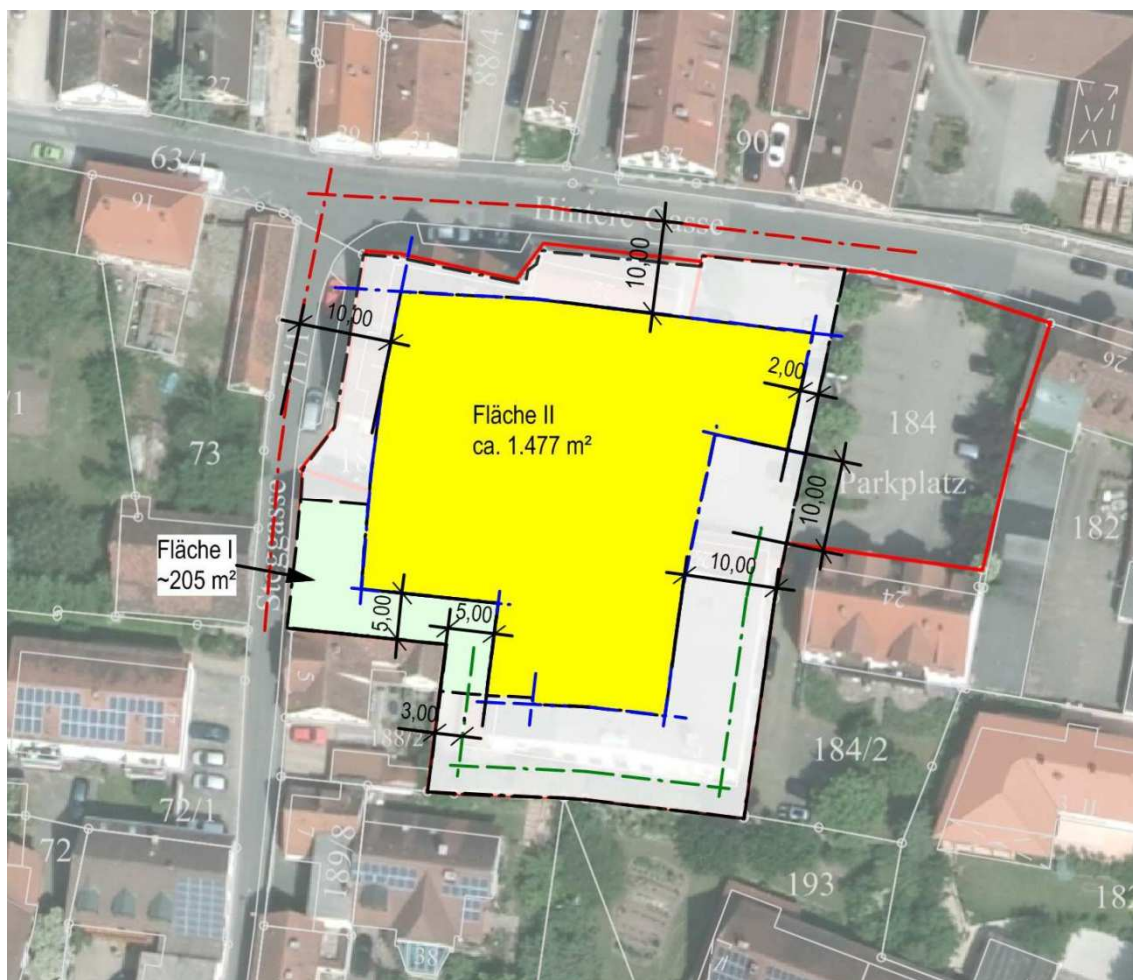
Bebaubare Fläche - Grundstück Vereinshaus
